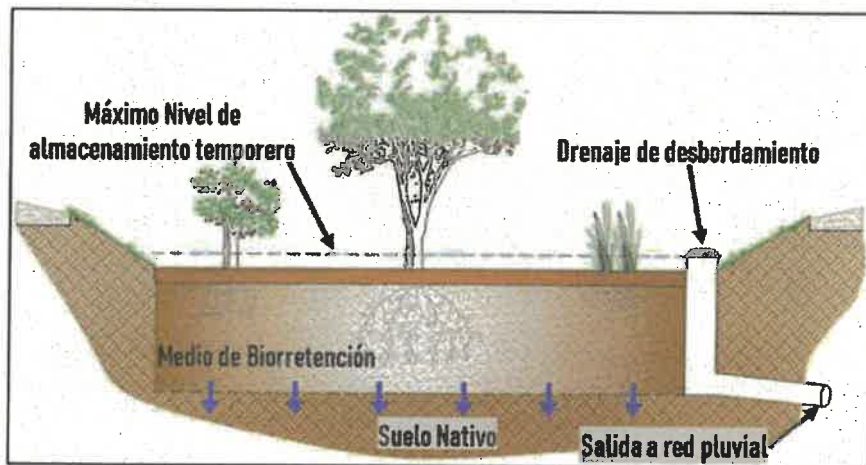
Drenaje para desbordamiento en sistema de biorretención.
